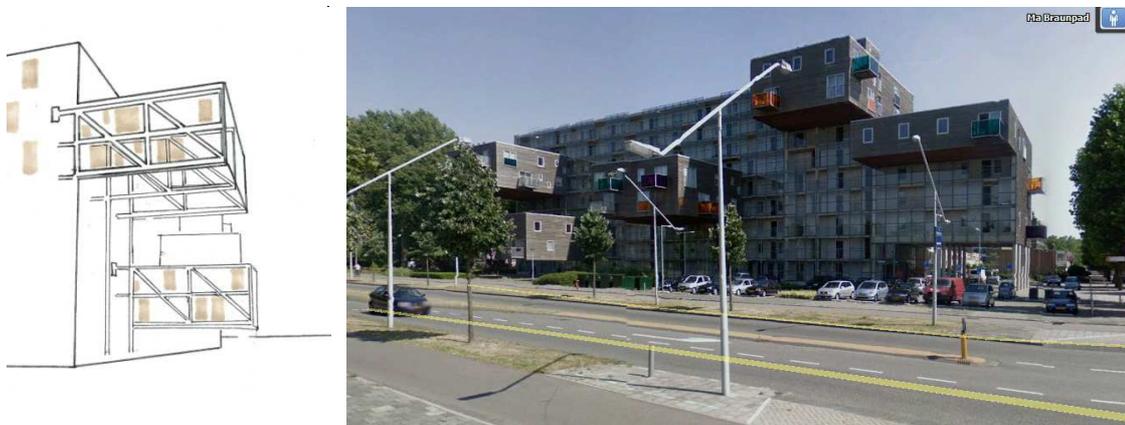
Esquema estrutural dos módulos em balanço e fachada norte.
